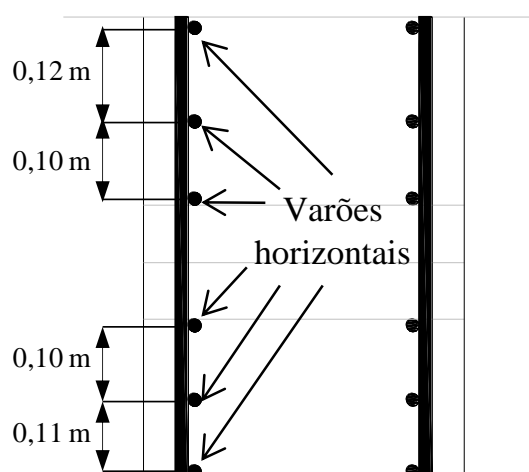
Zona de aplicação do GPR e espaçamento entre varões horizontais.
